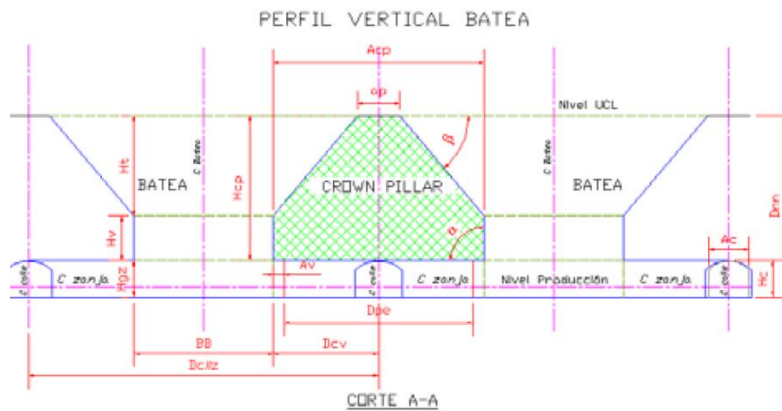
Diseño de Batea y Pilar Corona en perfil paralelo a galería de zanja. (Cavieres et al., 2002)
